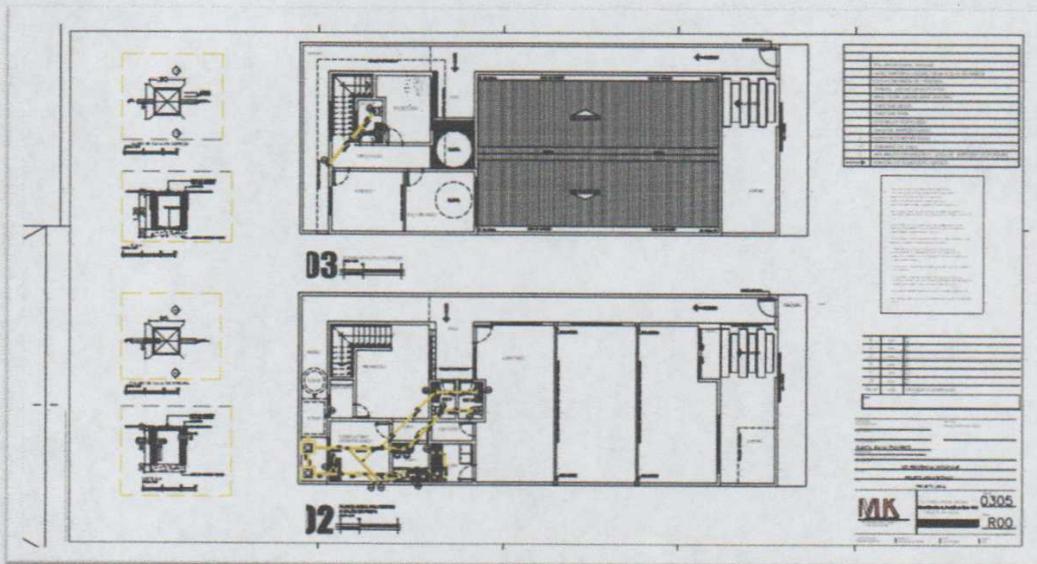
Planta baixa Pav. Superior. Planta baixa Pav. Térreo e salão de festa. Instalação predial de tubulação de esgoto.
